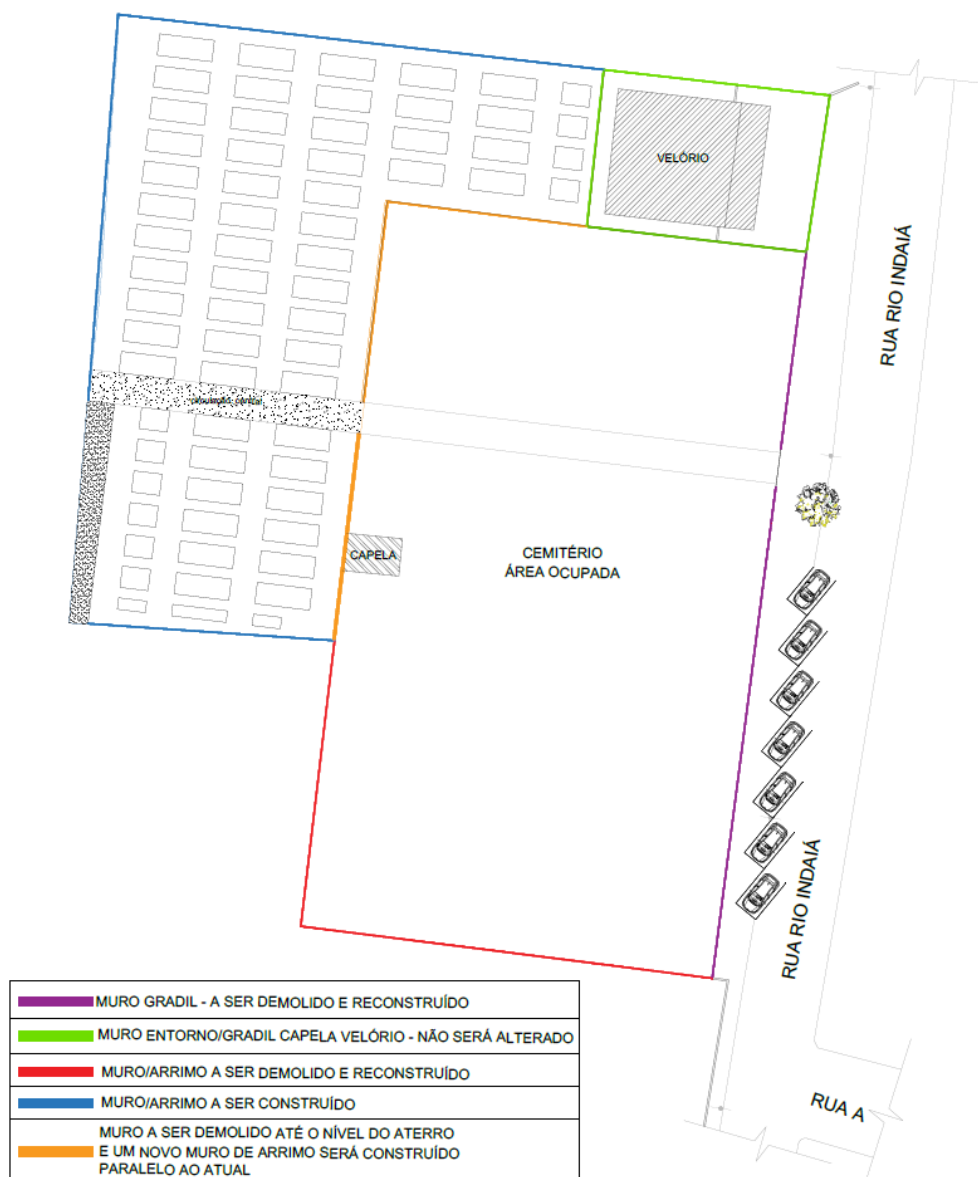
especificação de área de muros para demolição e construção/reconstrução
